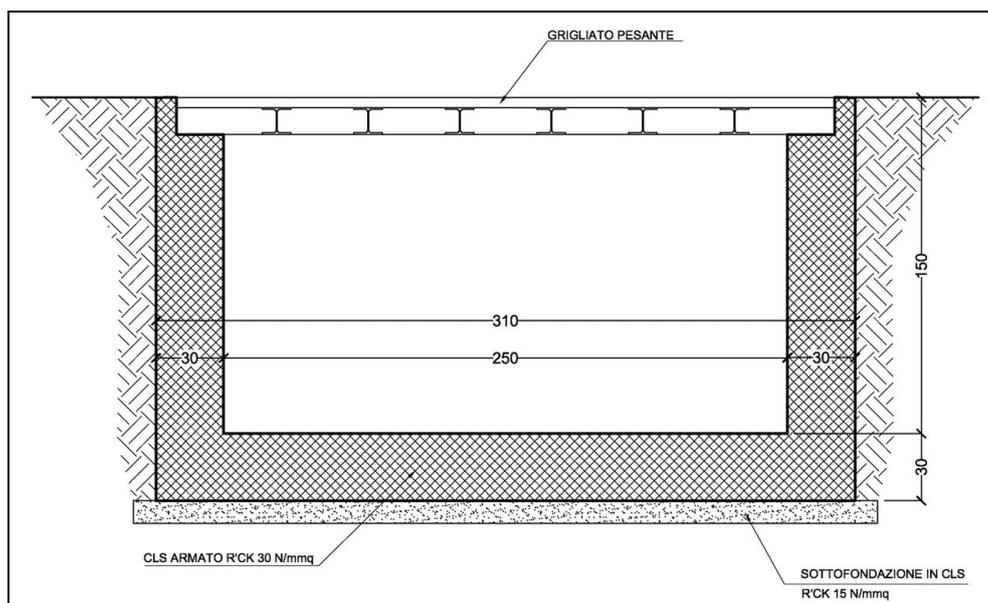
Compluvio centrale – Canale ad U in c.a. con griglia di copertura carrabile - sezione
